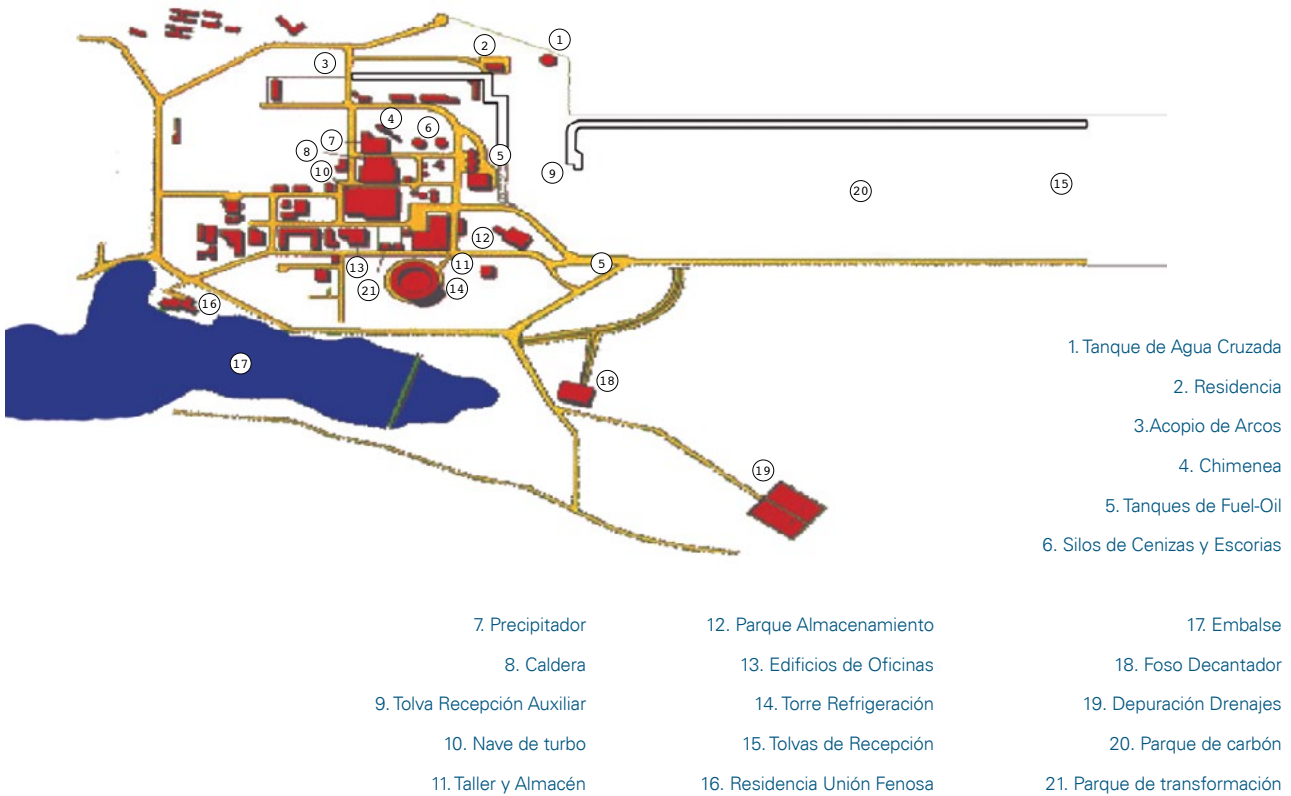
Plano de Planta de la Central Térmica de Anllares
